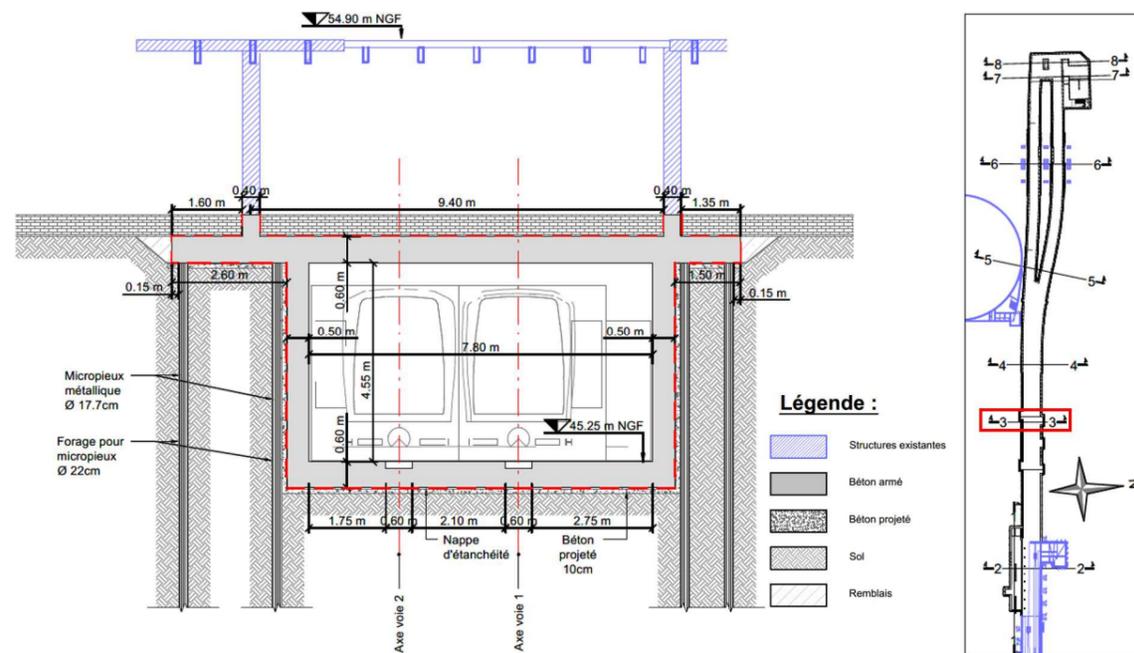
COUPE 3-3 DU TUNNEL AU NIVEAU DE LA ZONE KENNEDY (SOURCE : ARTELIA, NOVEMBRE 2022)
